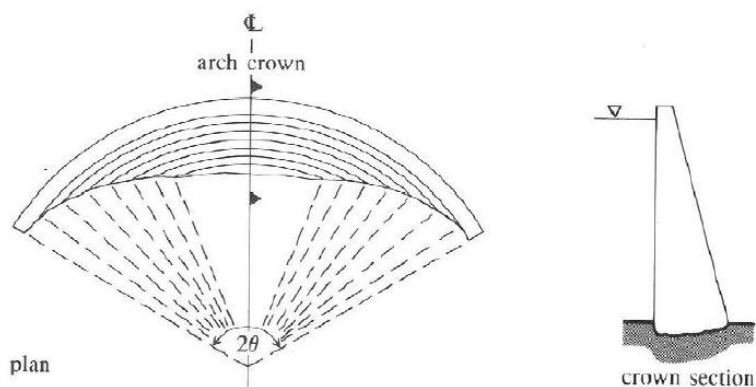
Presa arco con perfil de radio constante. Planta y sección transversal. (Fuente: CASTILLO [16])
